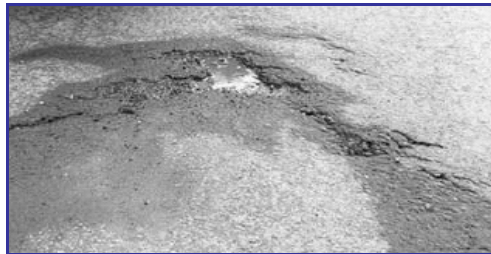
Grieta de desplazamiento.
